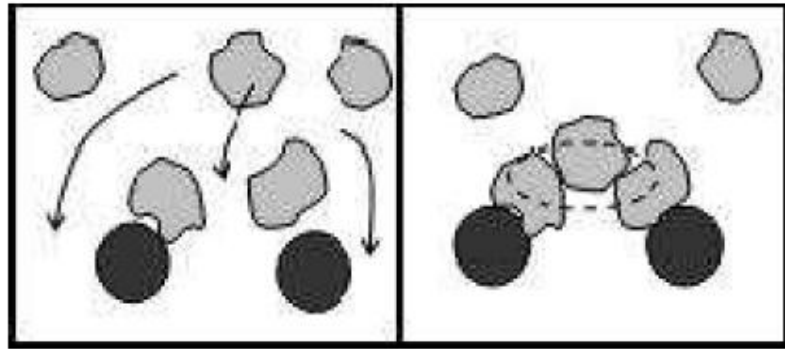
Représentation en plan d'un blocage de granulats à travers deux armatures
